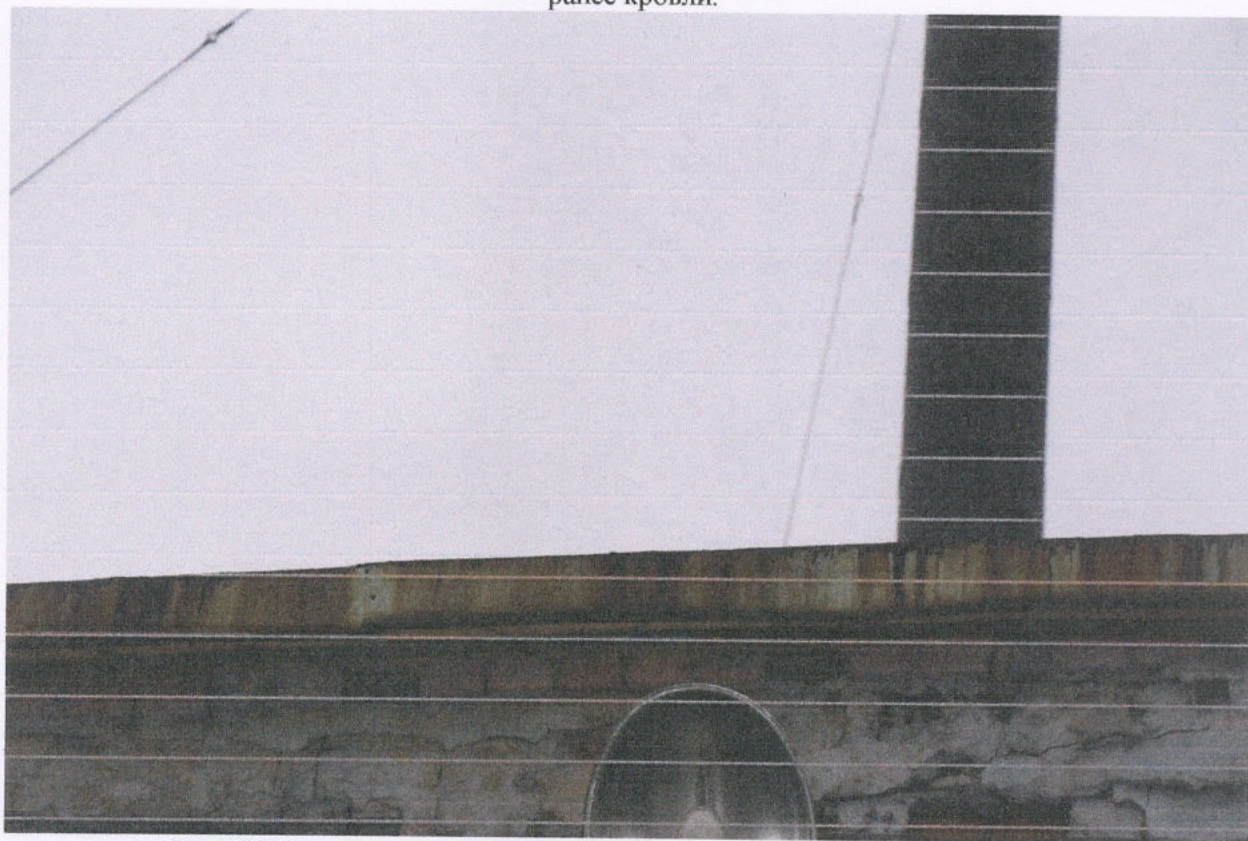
Разрушение штукатурного слоя из-за неисправной ранее кровли
